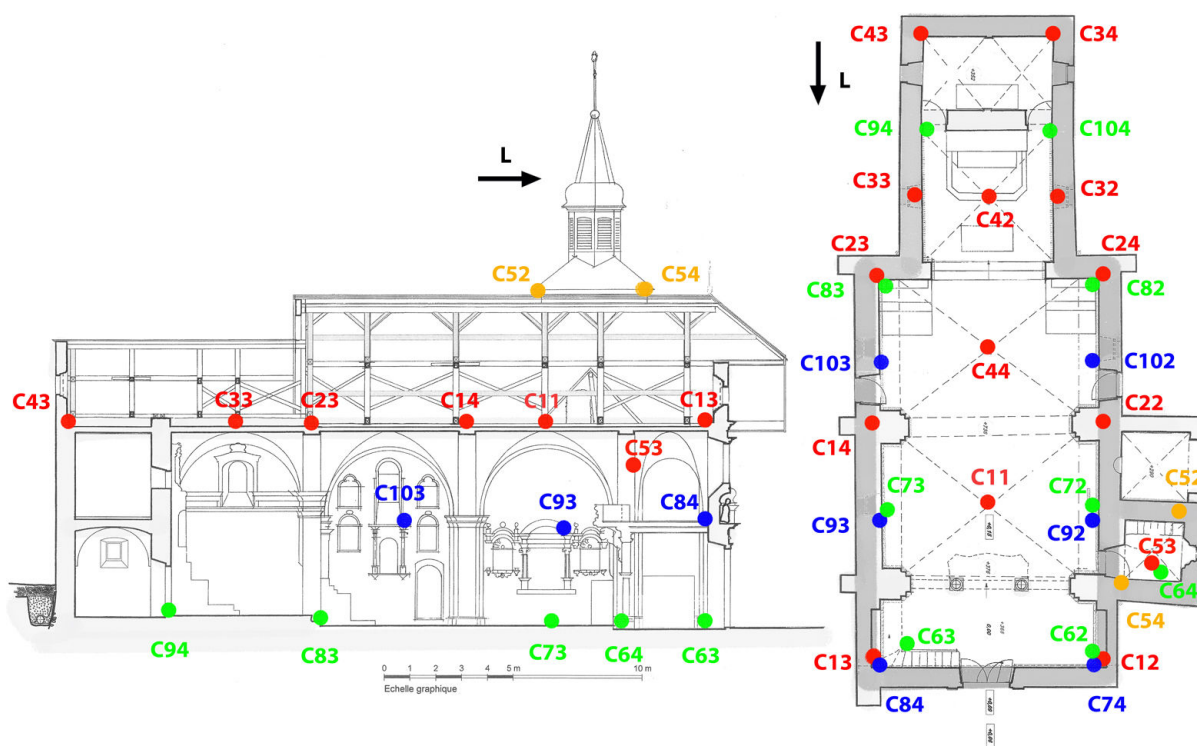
Exemple de position des capteurs pour les mesures complètes : NDG. Plan et coupe longitudinale avec positions des capteurs sur 4 niveaux.
